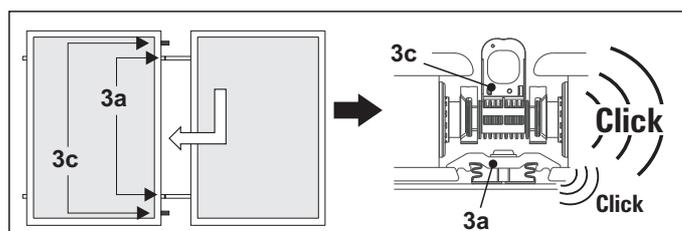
Fase di lavoro 6 con 2 e più collettori
